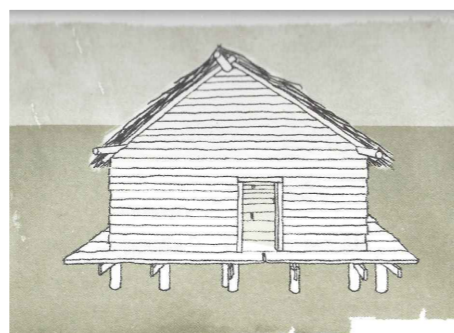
| Construção de uma palafita - Revestimento das paredes e cobertura.
